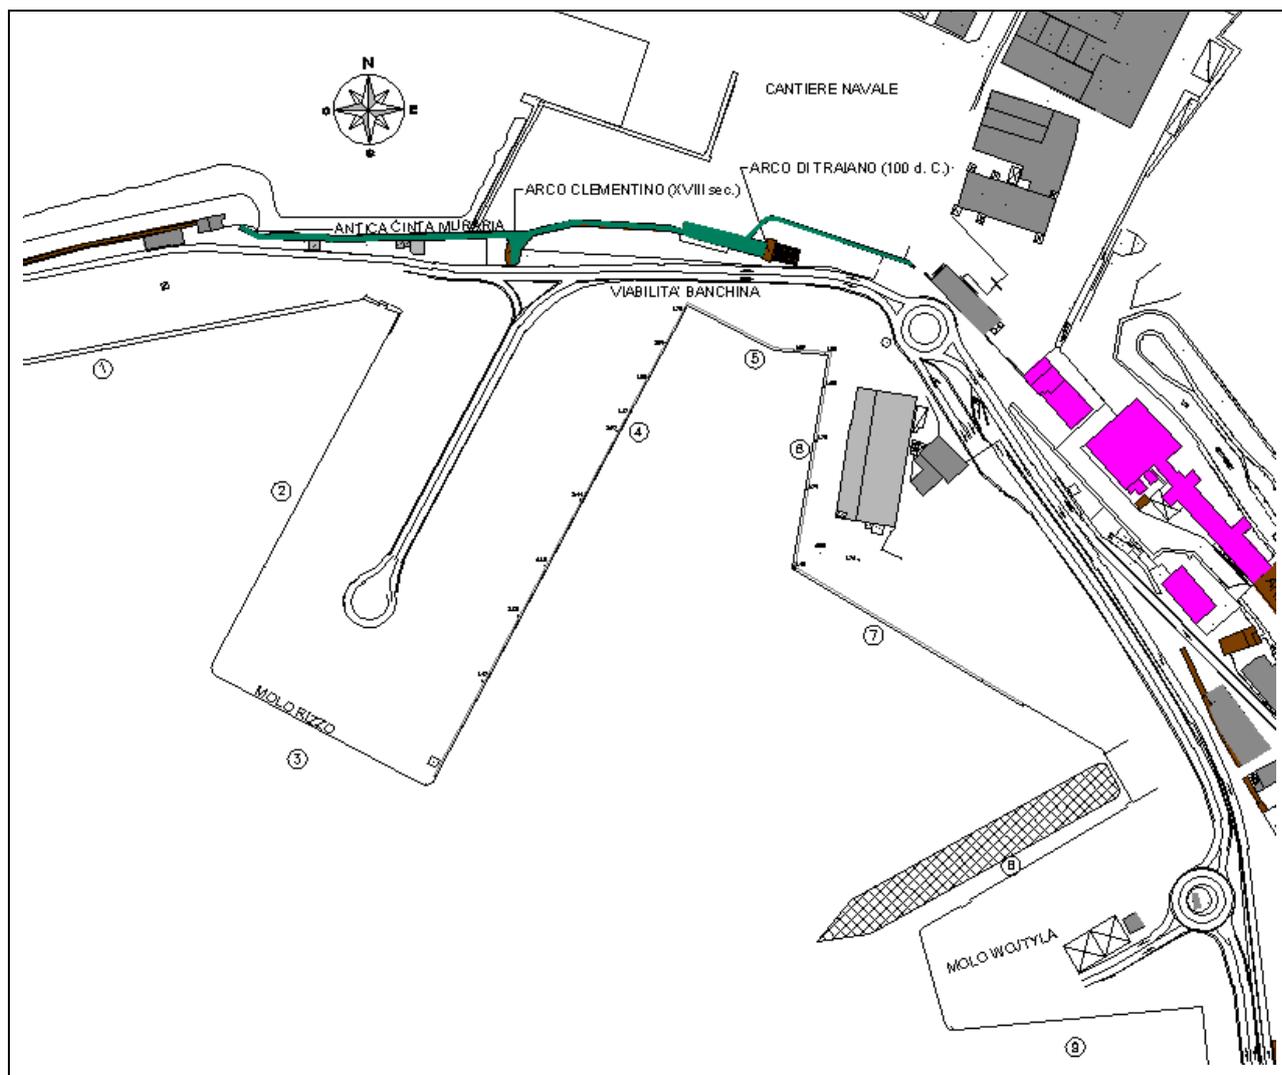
Profilo banchine 4-5 di progetto e viabilità banchina.
